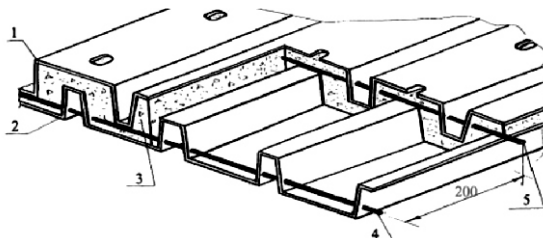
Конструктивне рішення залізобетонної плити перекриття з двома сталевими профільованими настилами та поперечними анкерами:
